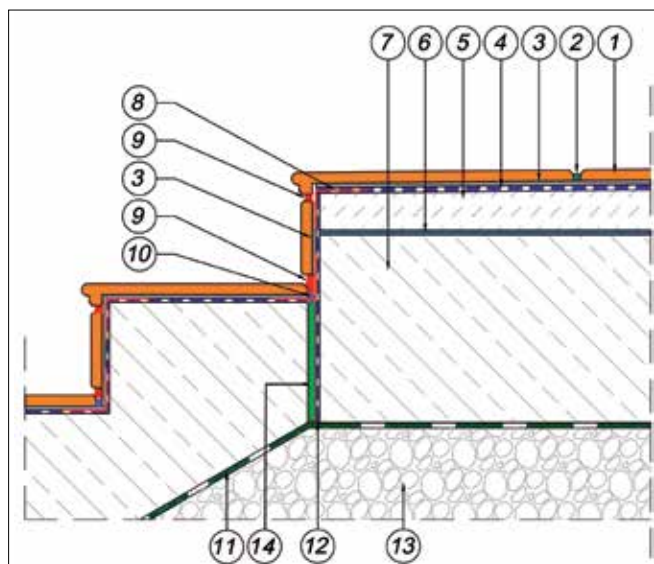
Wykończenie schodów płytami kamiennymi/betonowymi na zaprawie wodoprzepuszczalnej – detal przy gruncie (rys. Gutjahr): 1 – płyta betonowa/kamienna stopnicy, 2 – płyta betonowa/kamienna podstopnicy, 3 – spoina (cementowa lub elastyczna), 4 – warstwa szczepna między płytą betonową/kamienną a zaprawą wodoprzepuszczalną, 5 – zaprawa wodoprzepuszczalna, 6 – zbrojenie, 7 – taśma dylatacyjna, 8 – mata drenująca klejona punktowo do hydroizolacji, 9 – hydroizolacja – elastyczny szlam mineralny lub hybrydowa zaprawa uszczelniająca, 10 – konstrukcja schodów, 11 – geowłóknina
